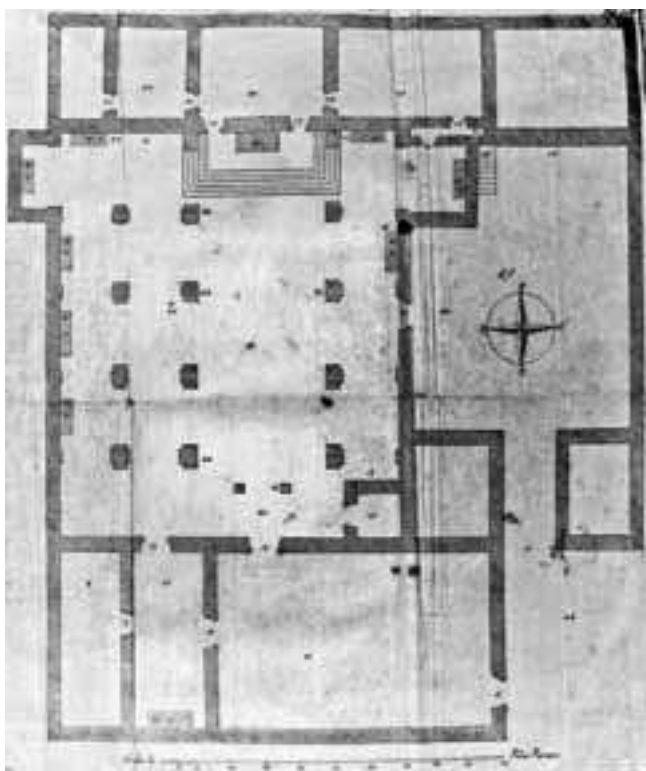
Planimetria della basilica tratta da MEZZADRI 1769
